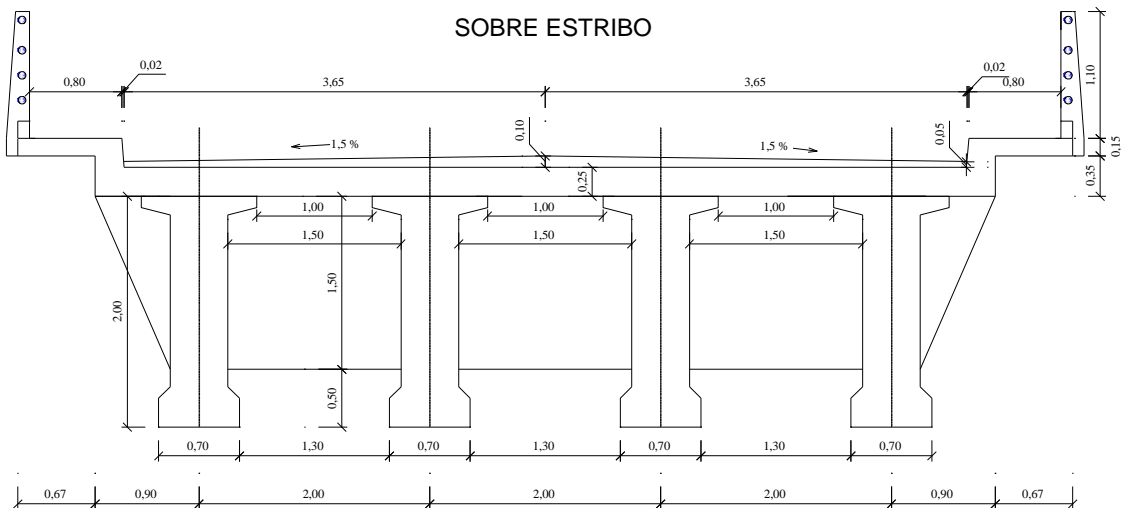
Geometría de la Viga Preesforzada en apoyos:
